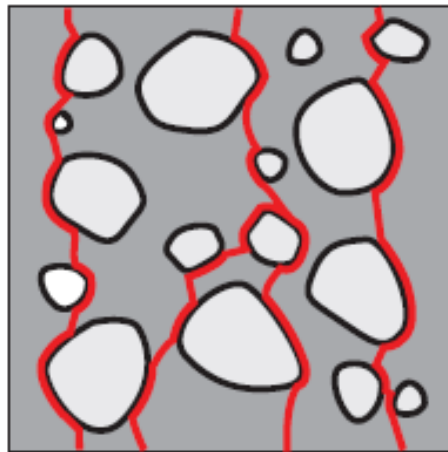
Béton ordinaire : fissures d'adhérence et fissures dans le mortier.
